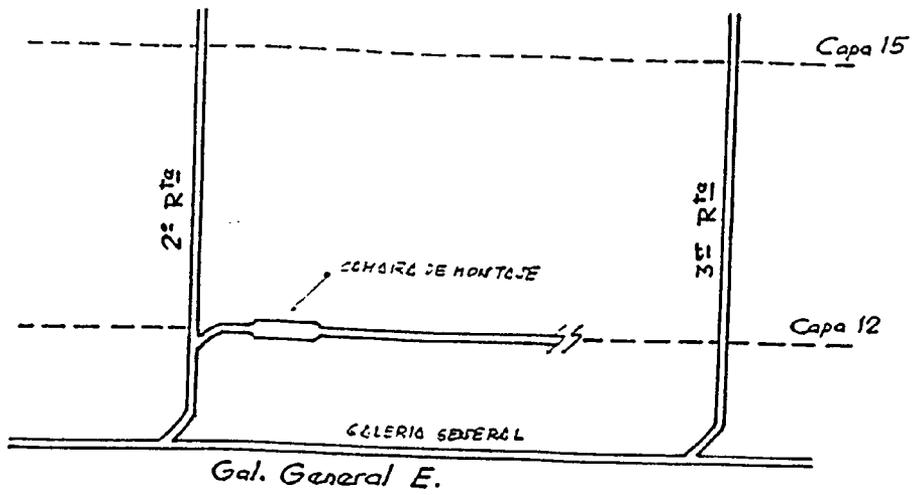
UBICACION DEL ENSAYO EN 6ª PLANTA
